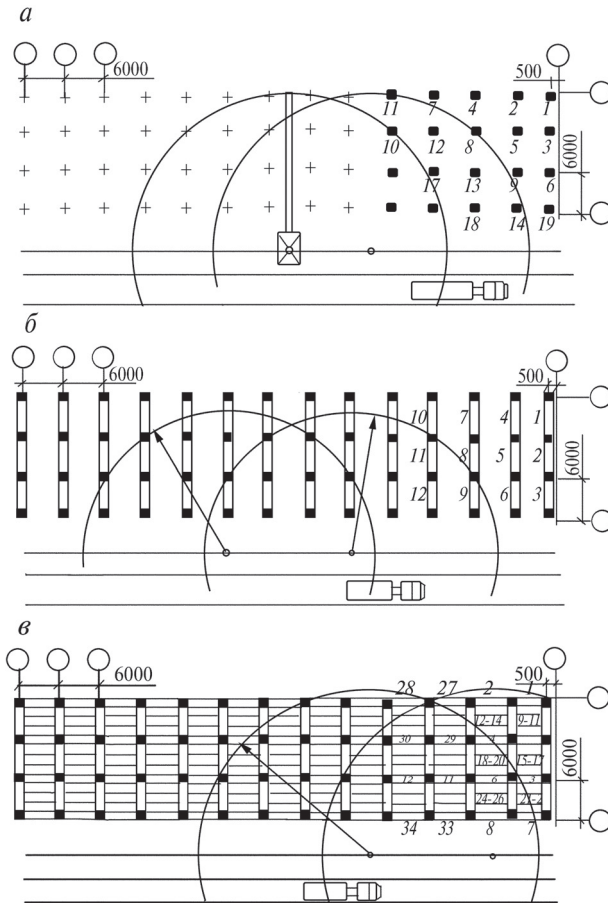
Схема монтажа бескрановых промышленных зданий башенным краном, установленным с одной стороны:
